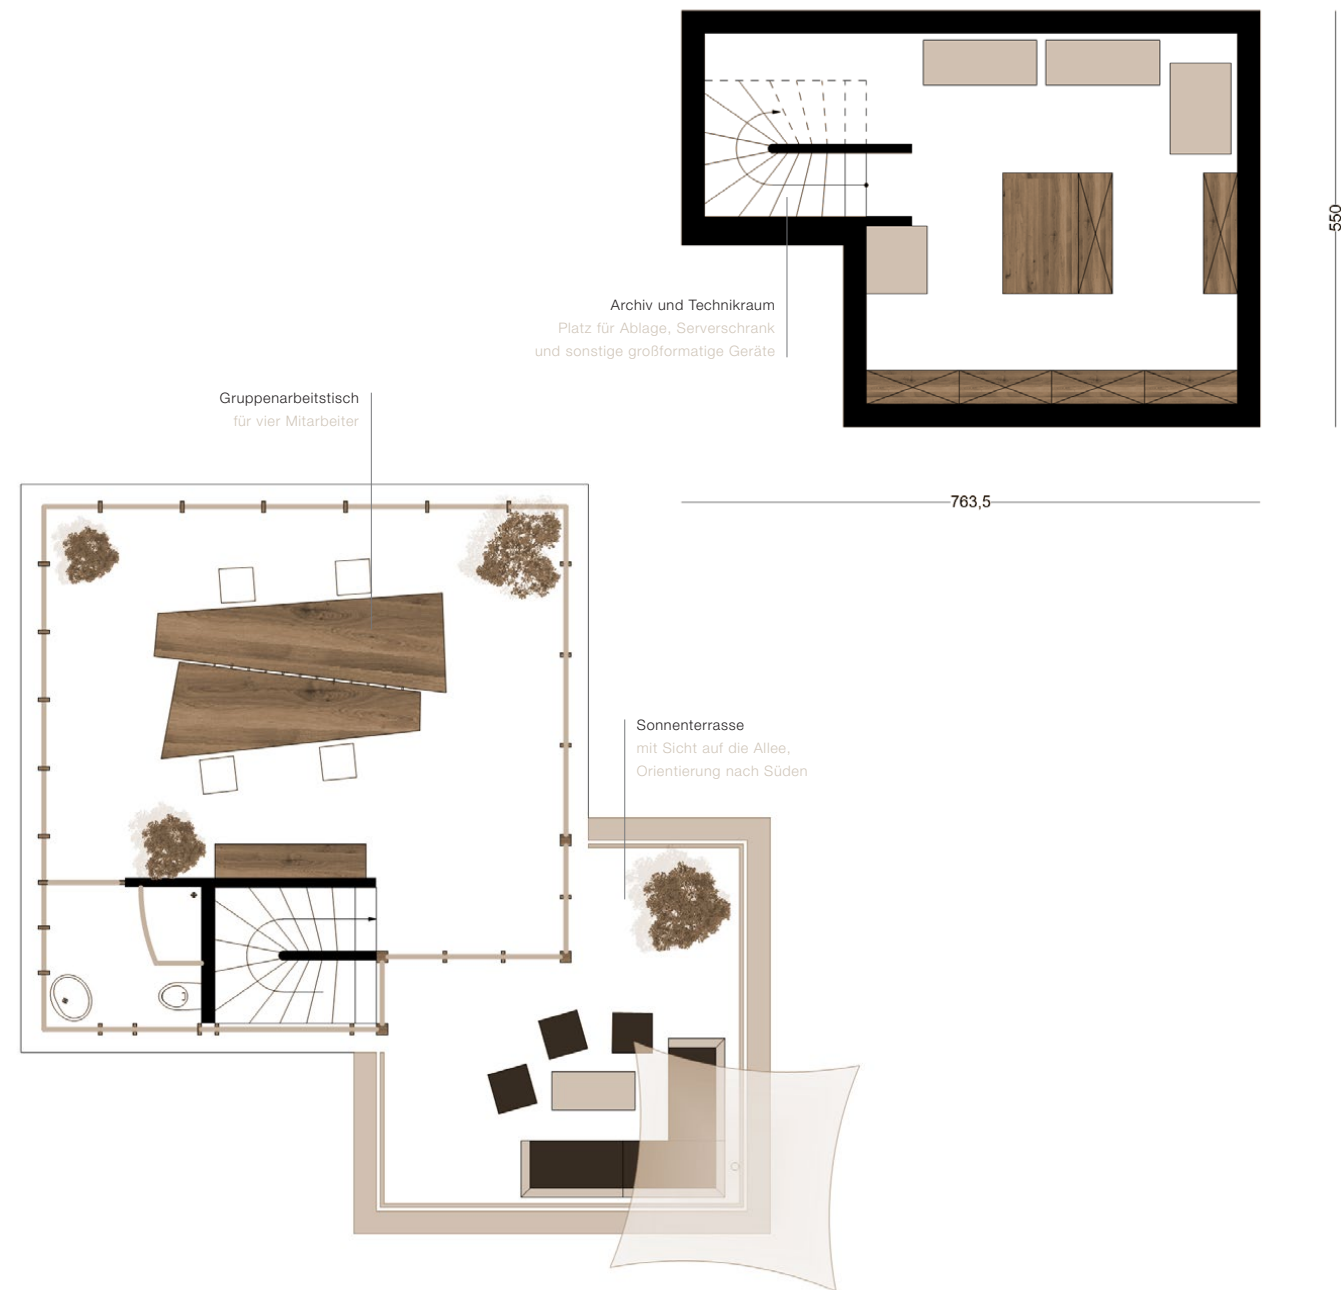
| Büro, Grundriss (Obergeschoss)
